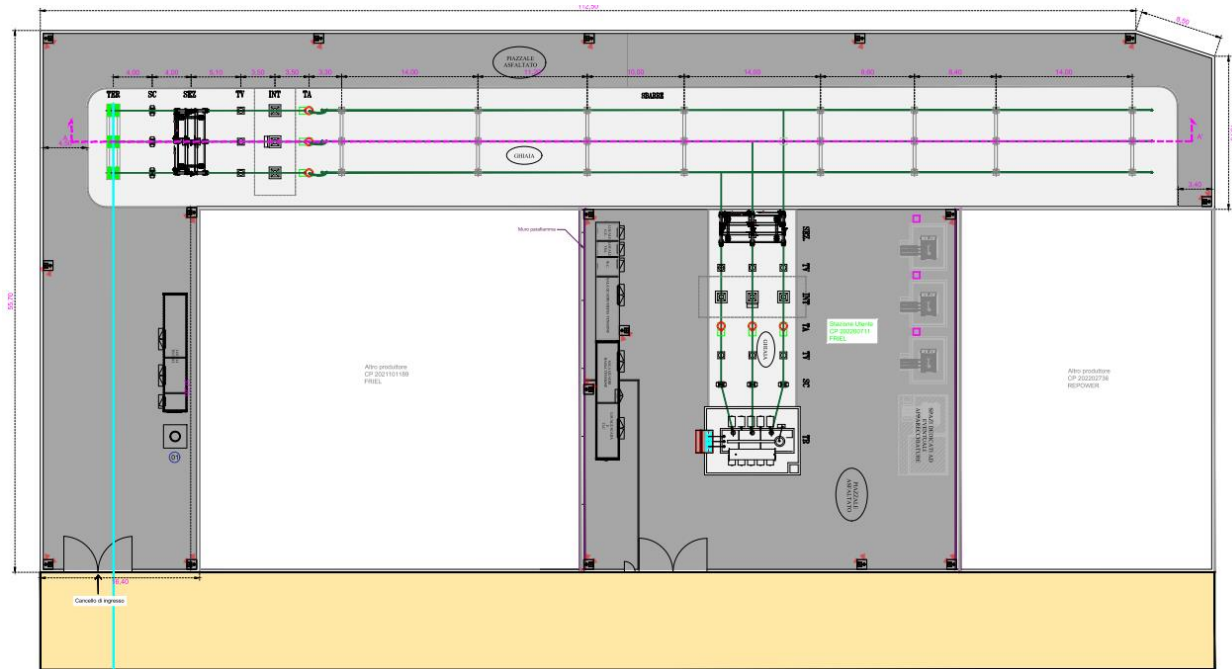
Planimetria elettromeccanica stallo condiviso NORD
